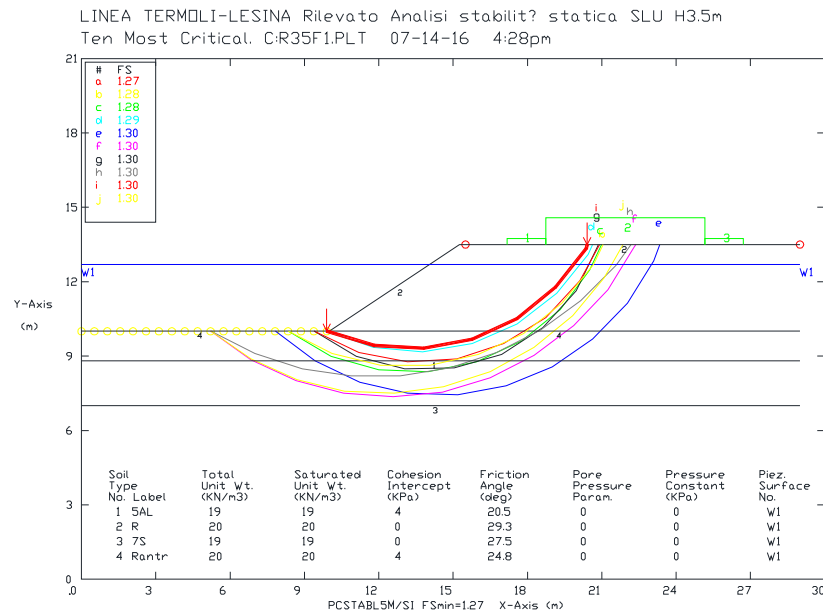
Analisi statica SLU +rilevato saturo in assenza di battente idrico – rilevato al km 0+350 (H= 3.5m)
